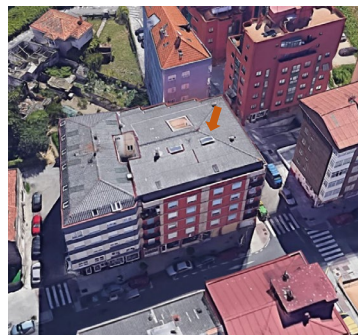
Vista aérea de la fachada Oeste del edificio situado en la Rúa Eugenio Kraff, 11.
